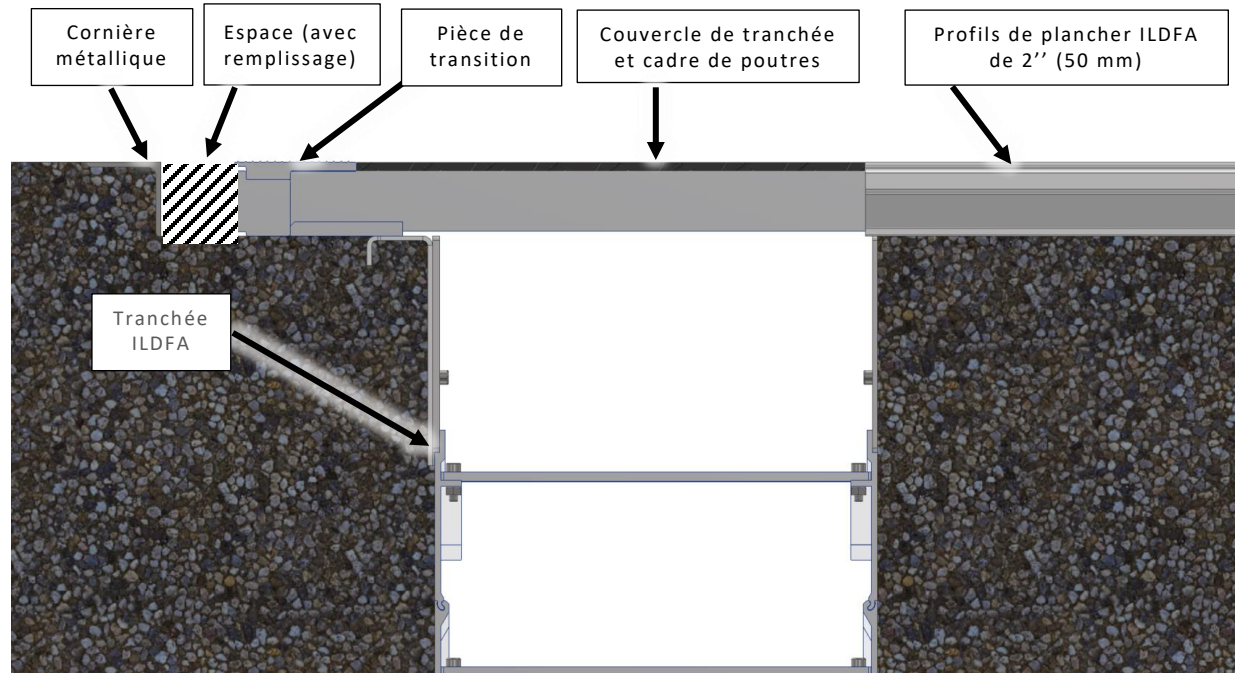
Transition entre la dalle du hangar et l'ILDFA au niveau des caniveaux
